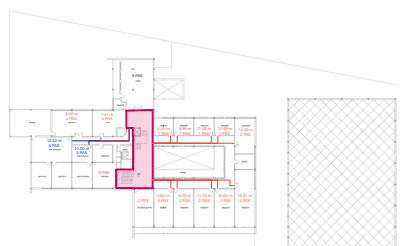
Accesibilidad propuesta planta primera pabellón E.
